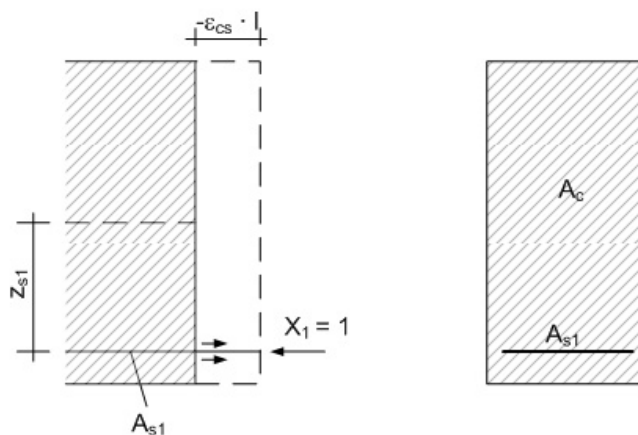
Kraftübertragung bei Betonschwinden und einlagiger Bewehrung
